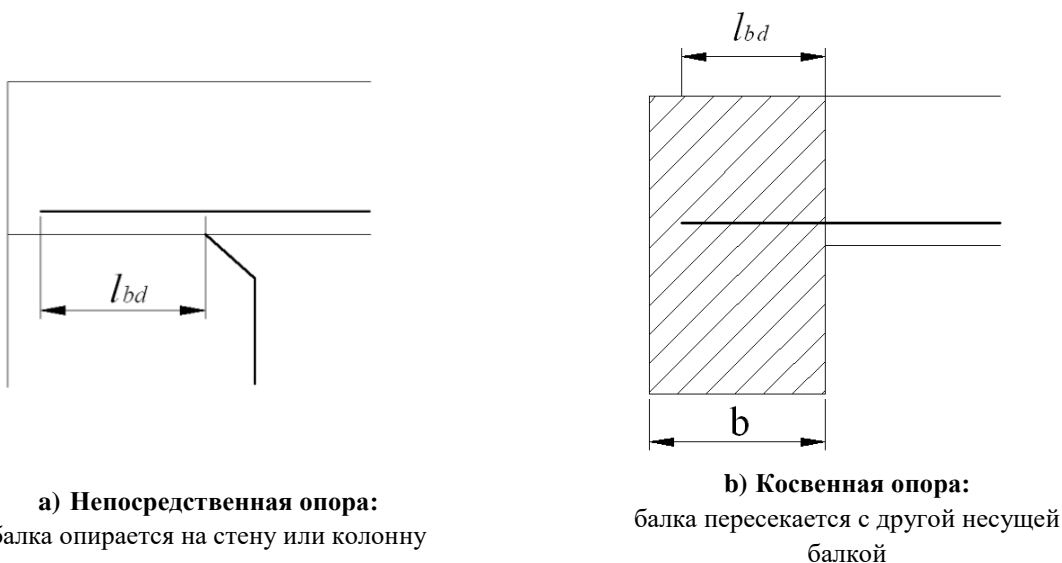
Анкерование нижней арматуры на крайних опорах
